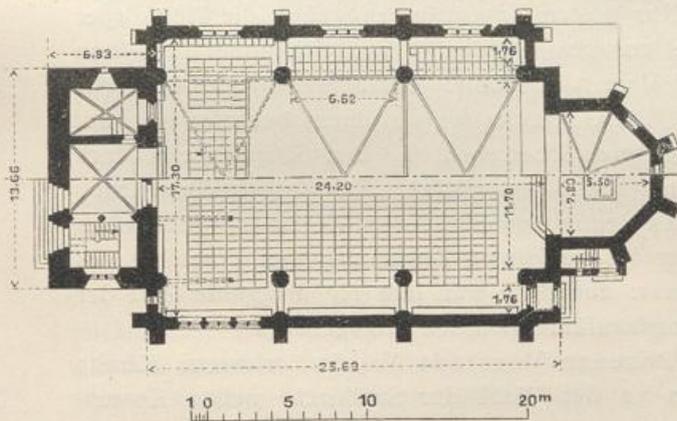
Grundriß zu ebener Erde und über der Empore.
